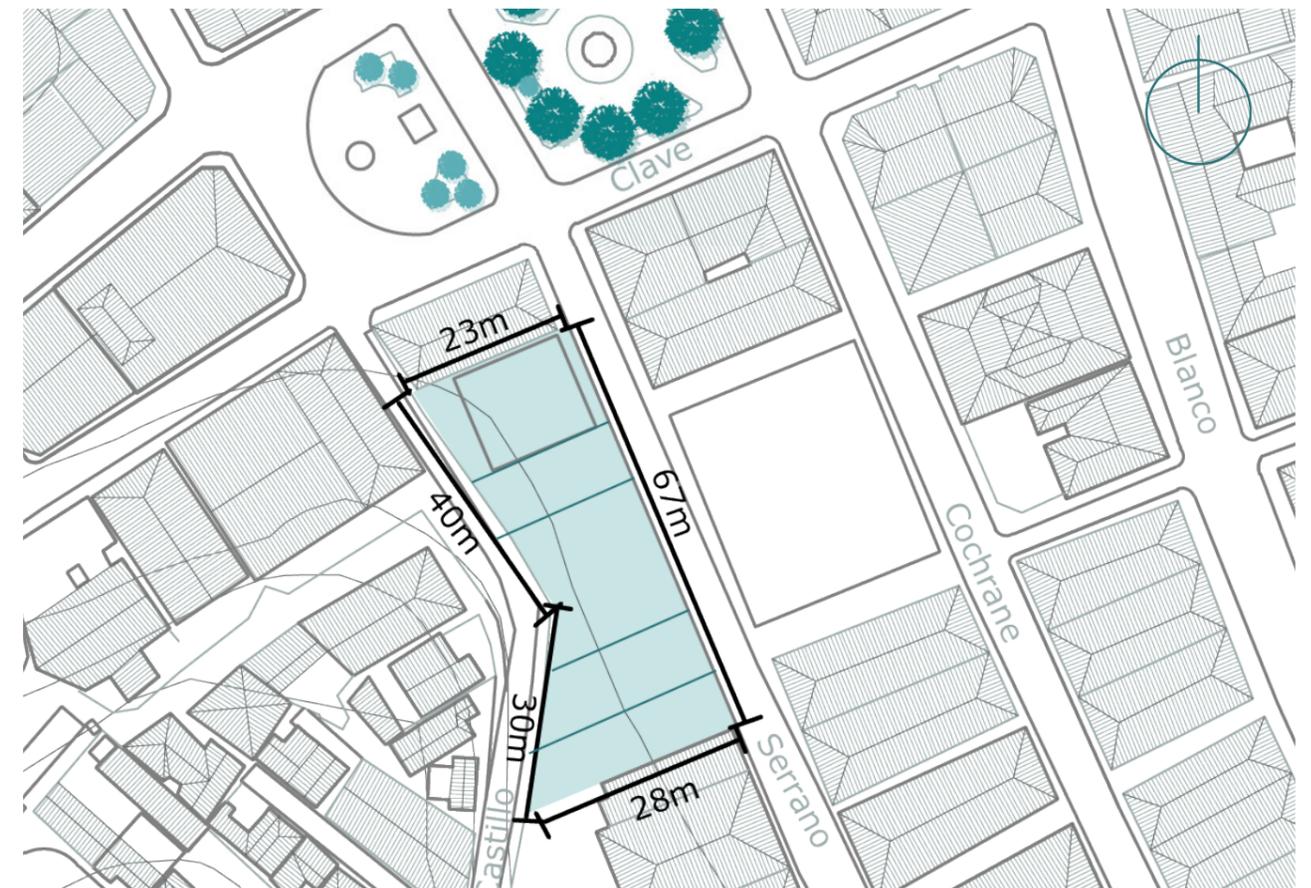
Plano esquemático emplazamiento terreno escogido. Fuente: Elaboración propia. (2023)
